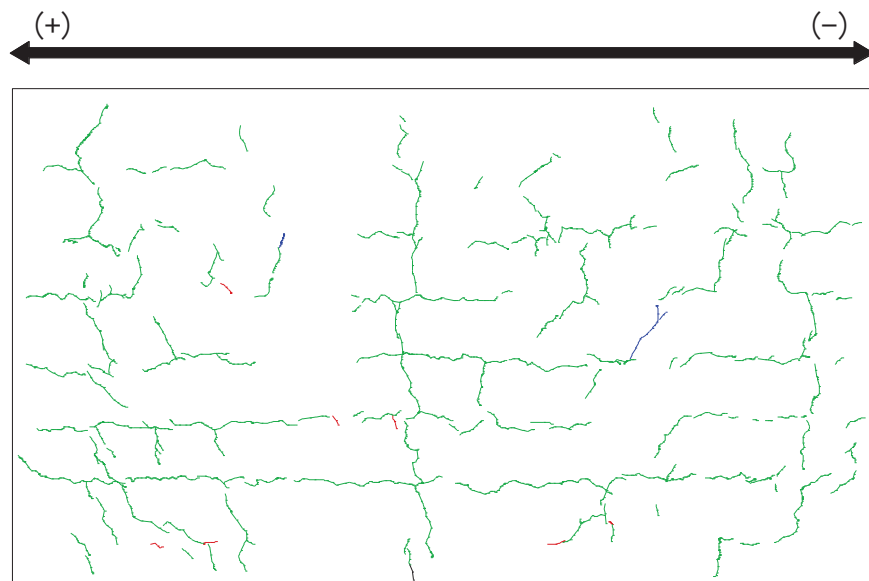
(2) 乾燥試験体 [2] 1/10000rad. におけるひび割れ図
